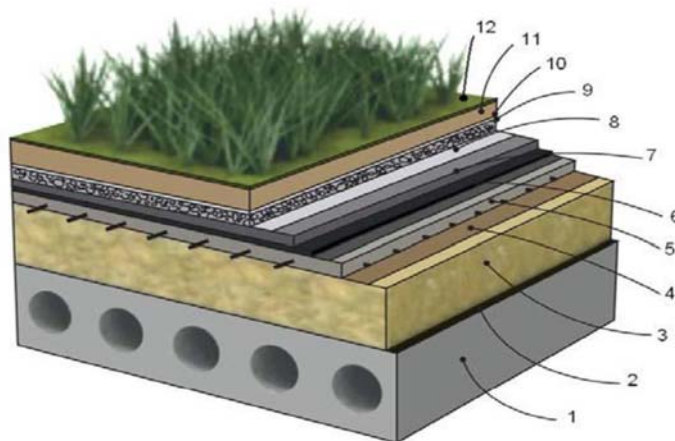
Схема конструкции «зеленой» крыши: 1 — несущая конструкция; 2 — пароизоляция; 3 — теплоизоляция; 4 — водоизоляционный слой; 5 — выравнивающая стяжка; 6 — гидроизоляция; 7 — мембрана; 8 — геотекстиль; 9 — гравий; 10 — геотекстиль; 11 — растительный грунт; 12 — озеленение.
